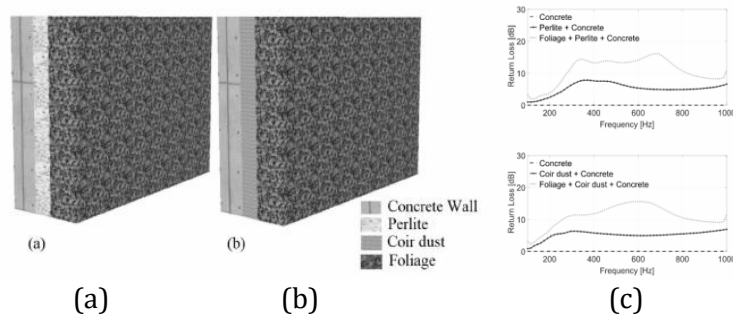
(a) Beton, (b) Pengujian Suara Beton
